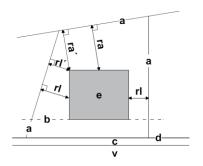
; MIX-v-Reculs réglementaires des constructions principales
